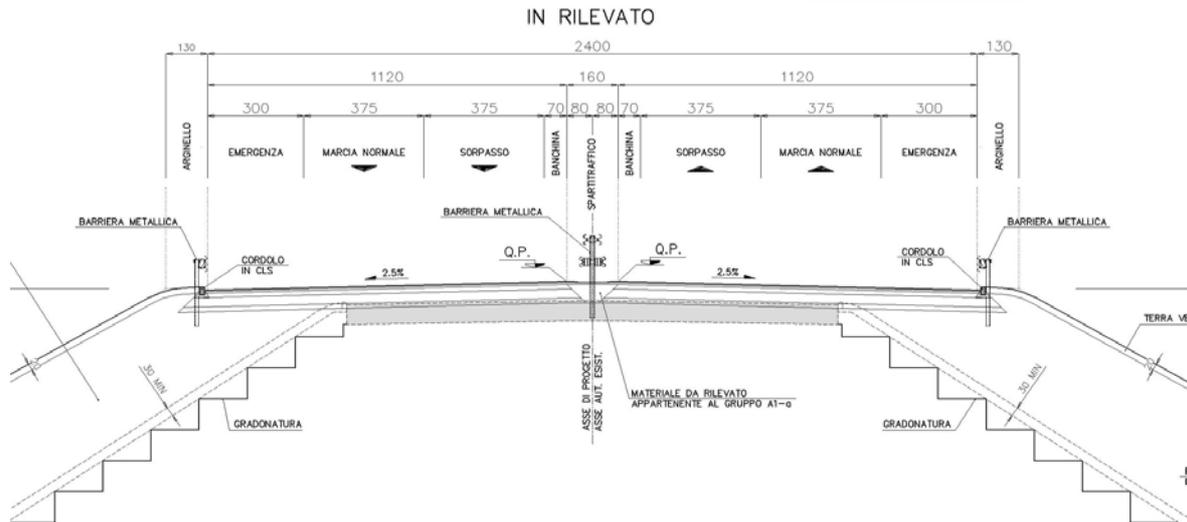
Sezione tipo di progetto (adeguamento SS1 Aurelia)
